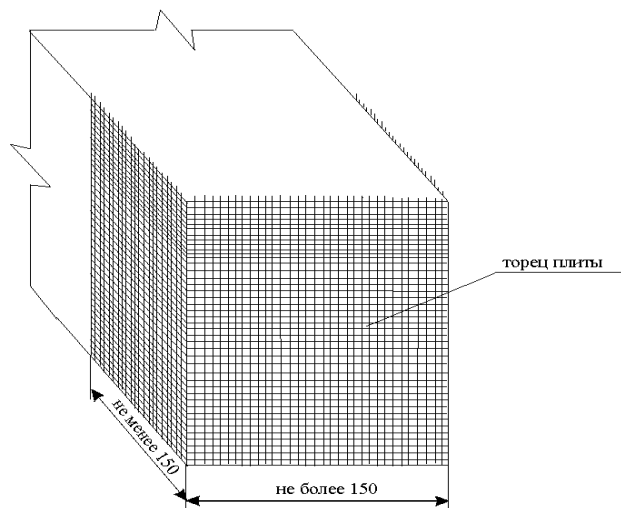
Фрагмент плитного утеплителя, на торец которого нанесены два слоя гидрозащитного штукатурного раствора, армированного стеклосеткой между ними.
